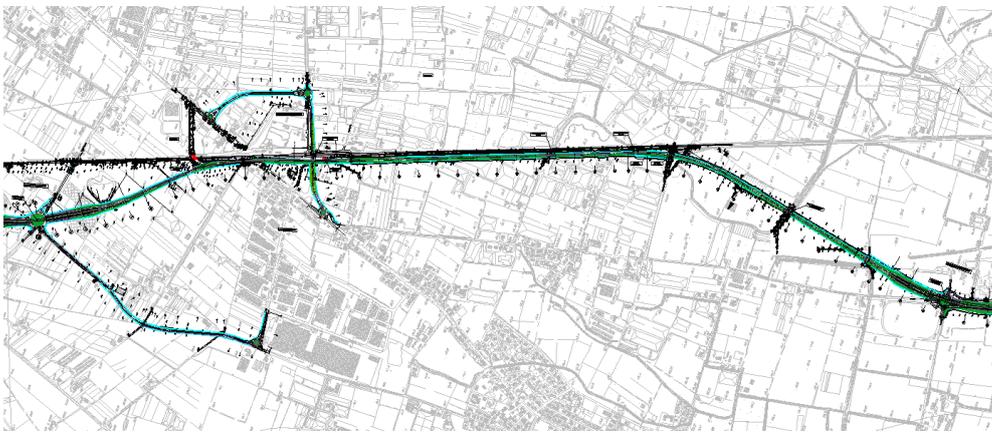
Tratto Svincolo di Via Cà Brusà - Svincolo di Castel d'Azzano – Planimetria
